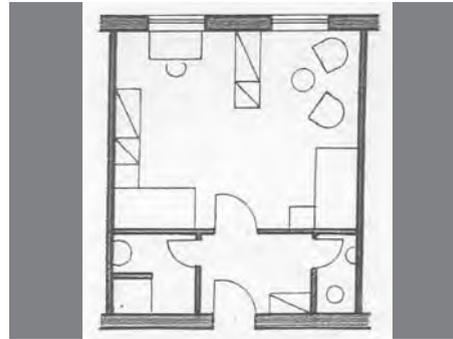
Grundrissdarstellung - Unterkunftsmodul B
